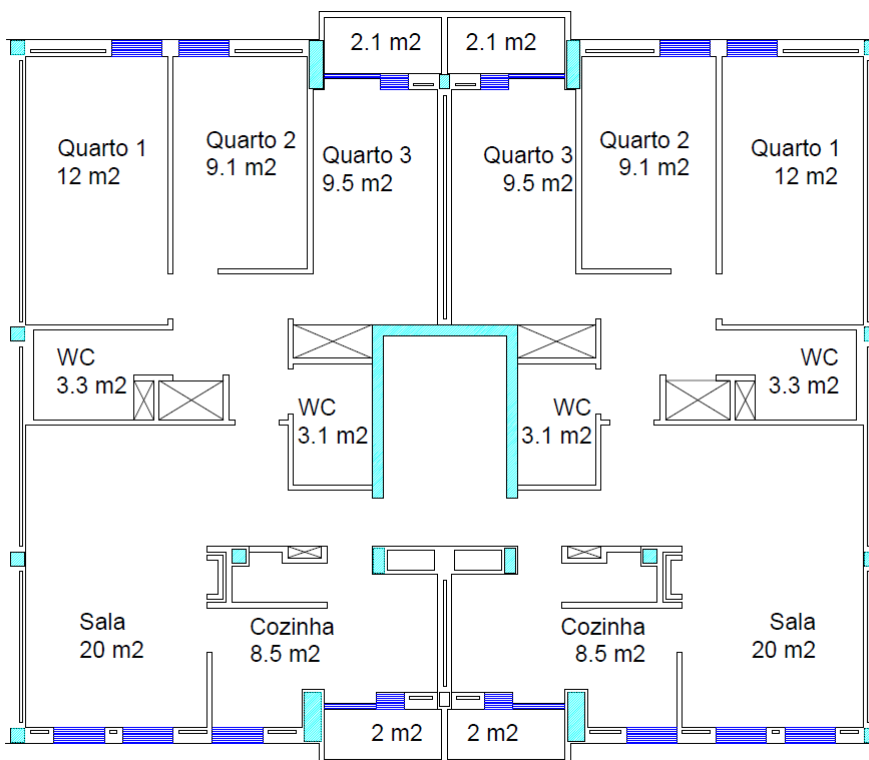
Planta tipo T3-T3 (1º; 2º)
